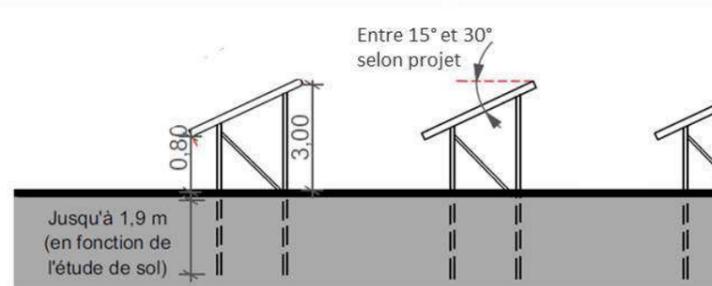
Plan en coupe de l'implantation (Source : EOLFI)
